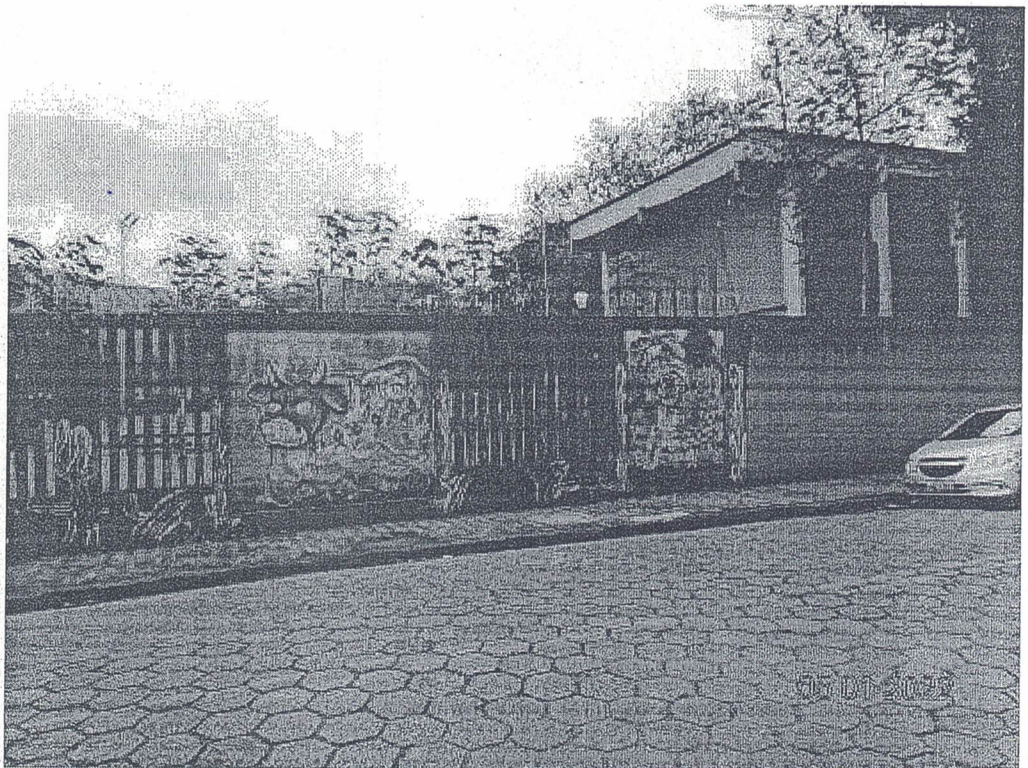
Vista da divisa lateral direita do imóvel, de quem da rua olha para o mesmo.
